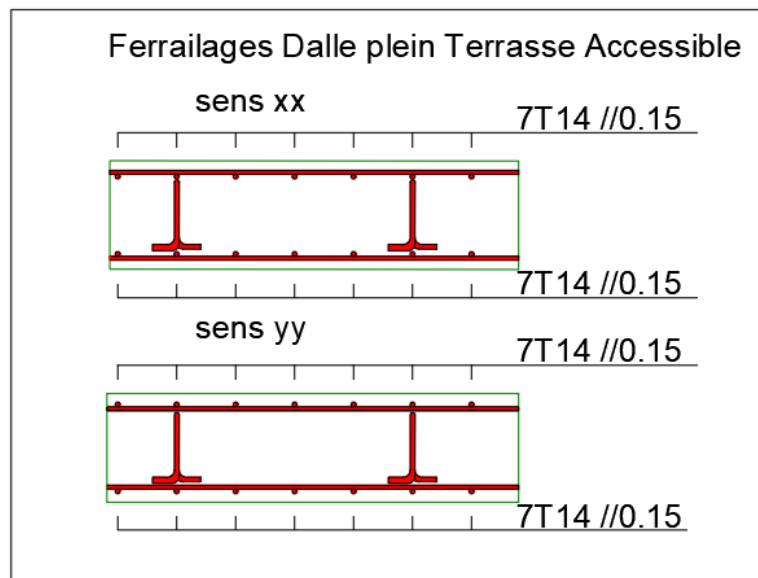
Schéma de ferrailage pour la dalle Terrasse accessible.
